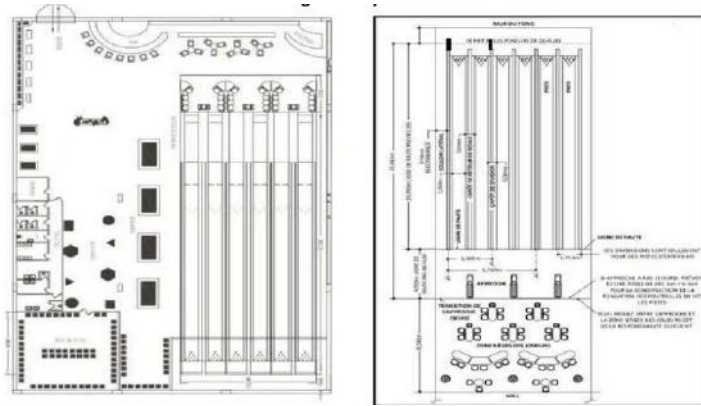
Plan de salle de bowling - source : guide de conception.
